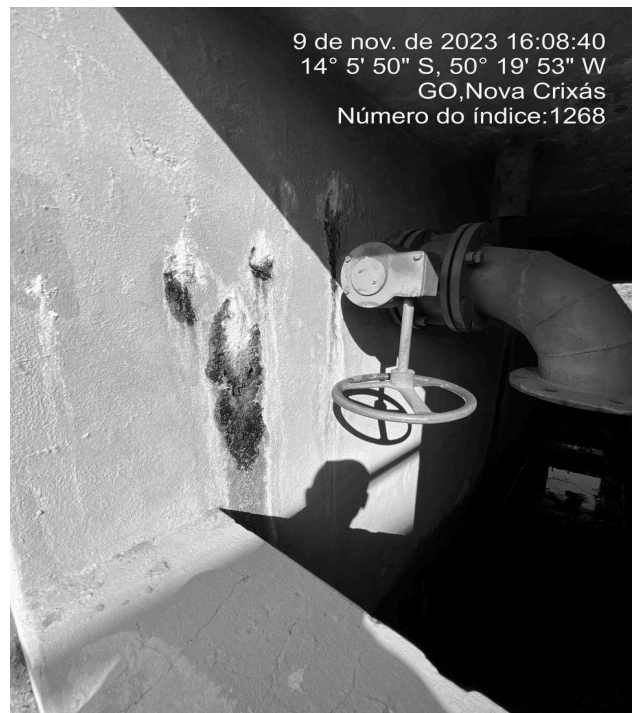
ETA/Filtração, com infiltrações na parte interna da galeria dos filtros.
